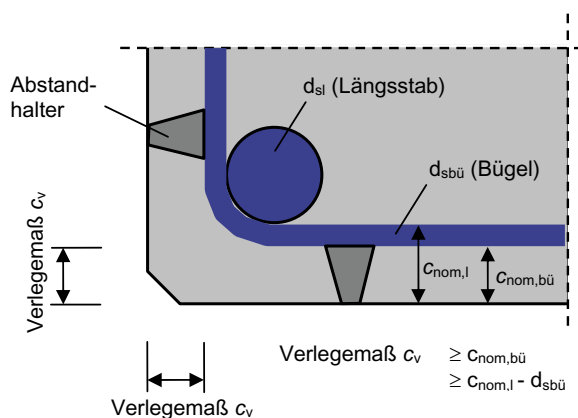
Betondeckung der Bewehrung eines Stahlbetonbalkens
